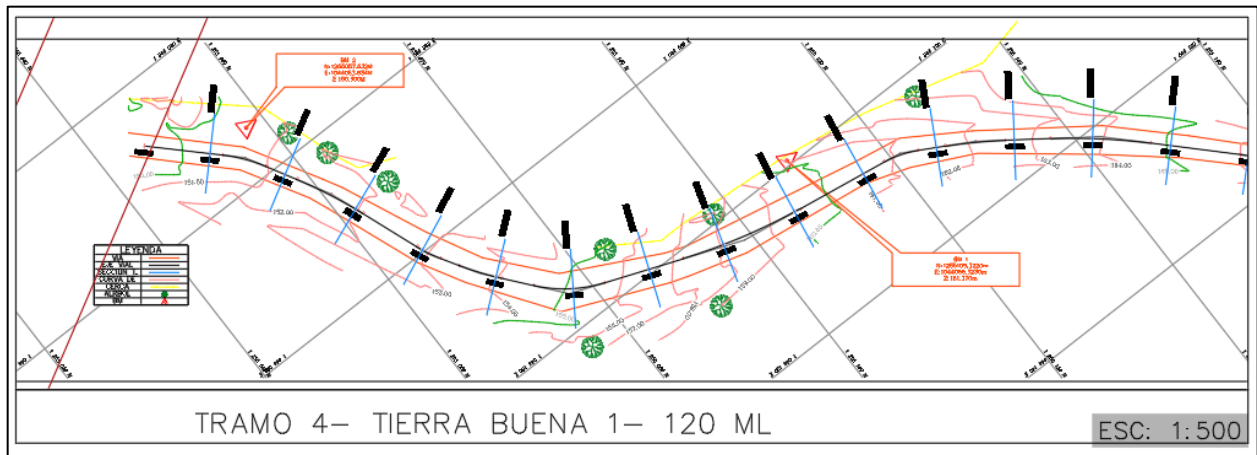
Imagen de planta del tramo 4 del proyecto de San Vicente de Chucuri-Santander
